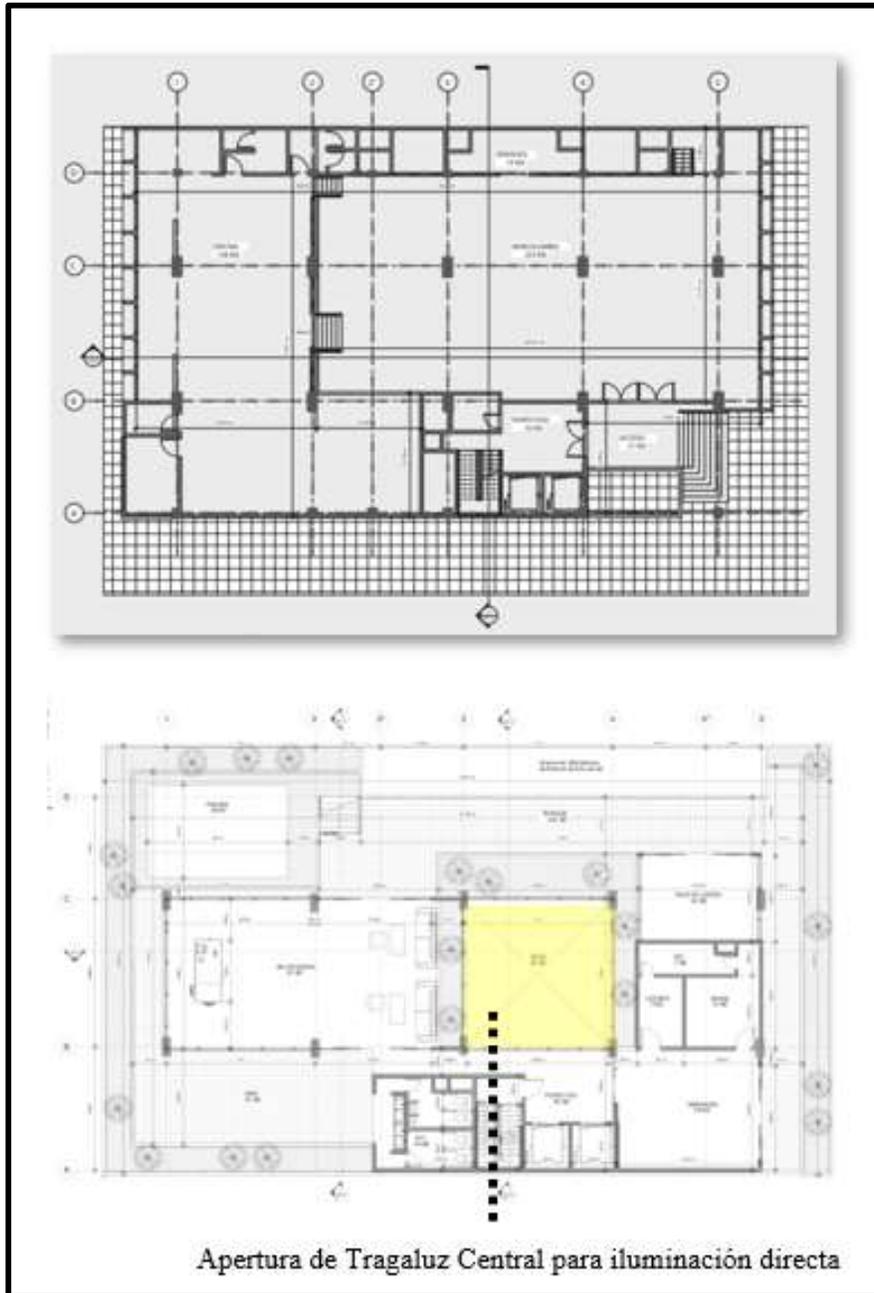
Planta Arquitectónica antes de intervención + Planta Propuesta en área de Transición
